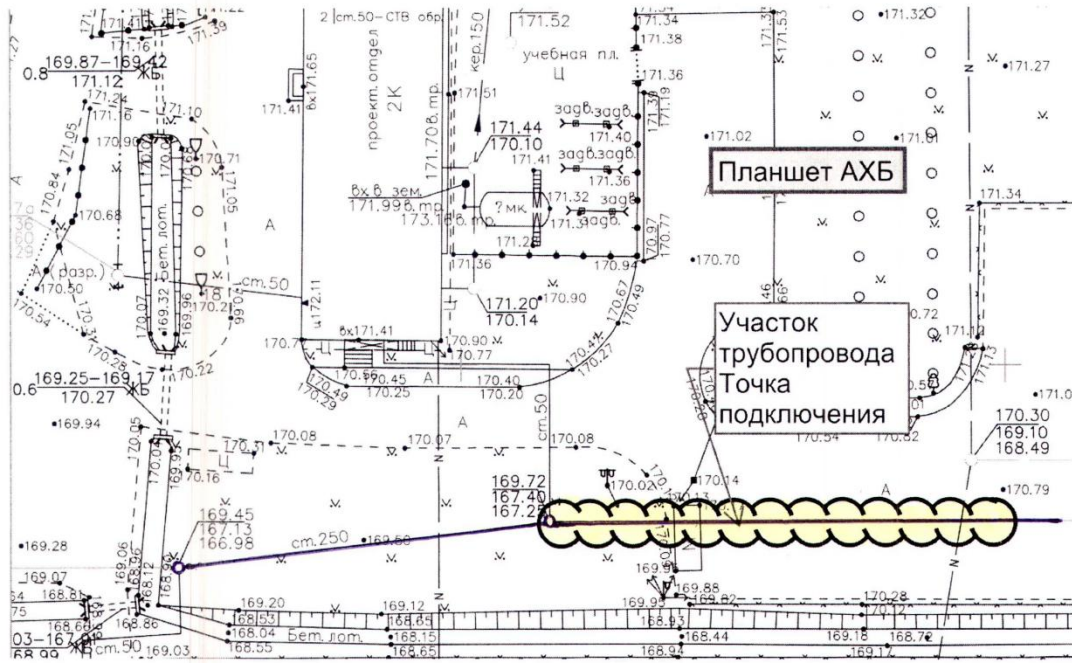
Схема подключения к сети ХПВ на планшете АХБ.
